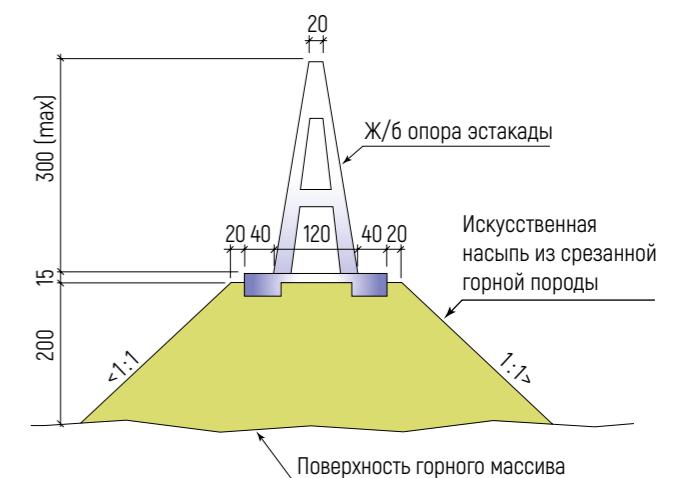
Пример выполнения железобетонной опоры (вариант)
